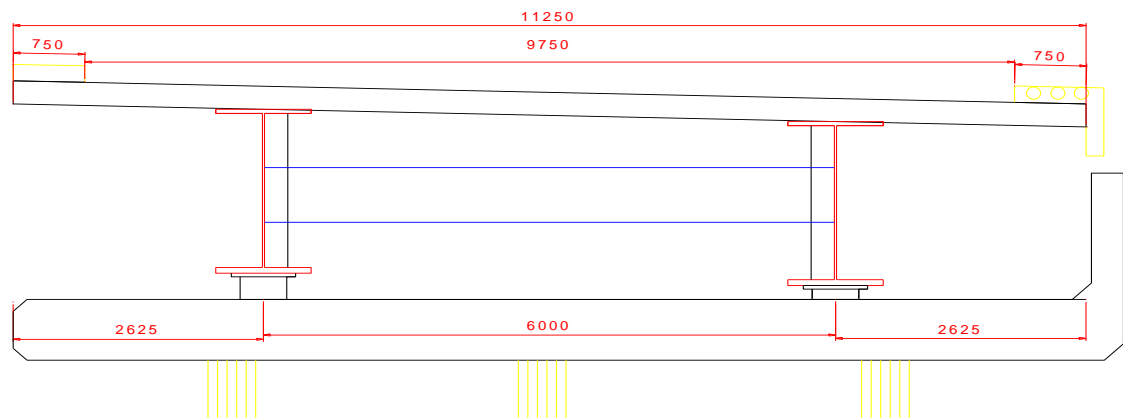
Coupe transversale du pont mixte (avec un dévers $i = 2.5\%$)
